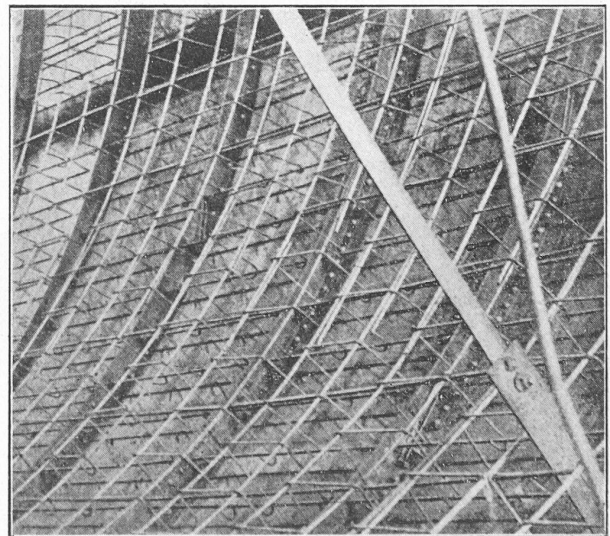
Tunnel à Détroit. Armature du revêtement interne, en béton armé.
